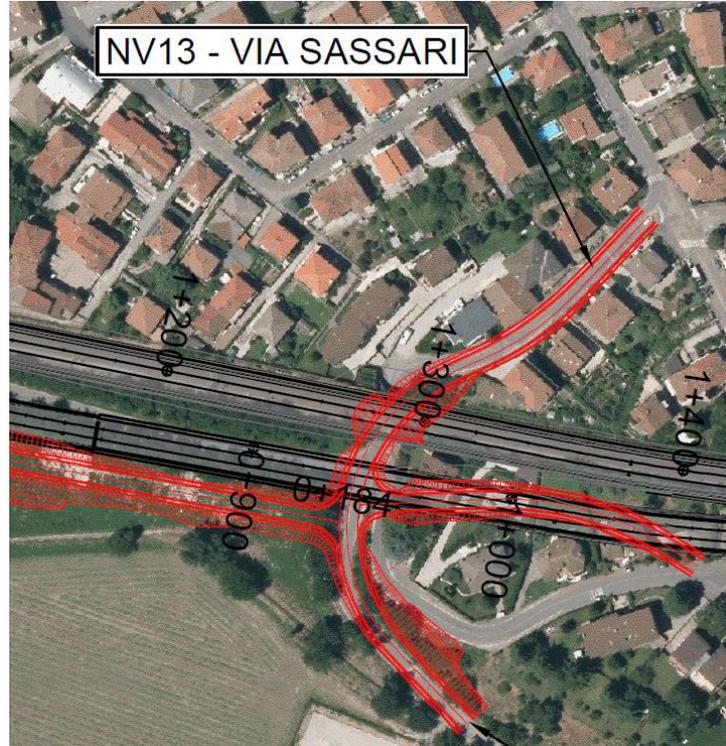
NV13 – Stralcio planimetrico su ortofoto di via Brigata Sassari e Via del Fortino (tratto Sud)
